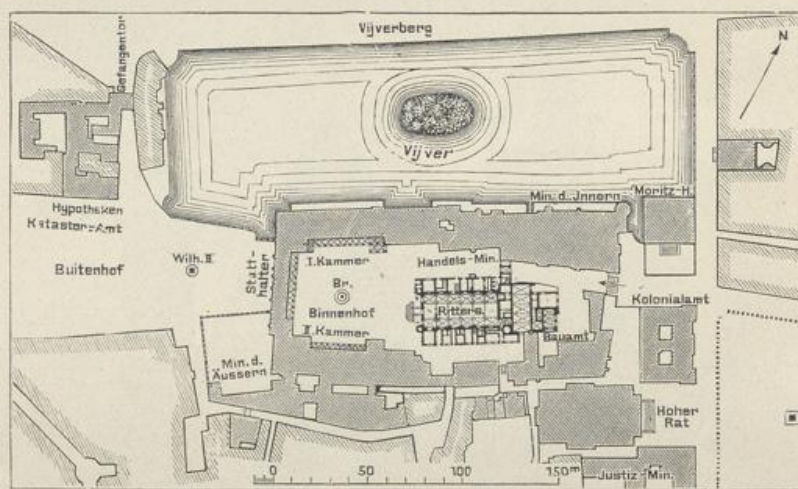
Binnenhof. Lageplan und Grundriß im Jahre 1891.
